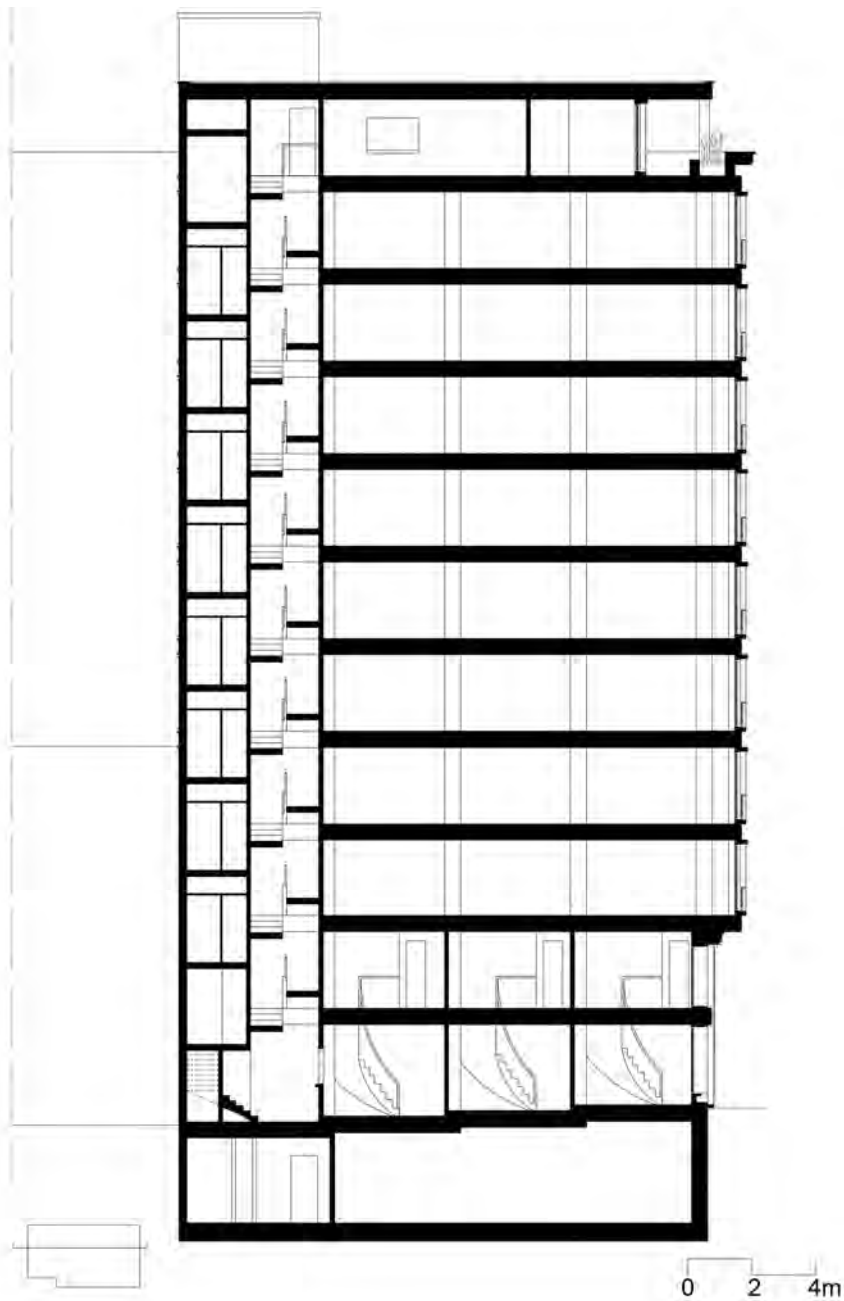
Quintana, sezione longitudinale. Fonte: elaborazione dell'autrice.
